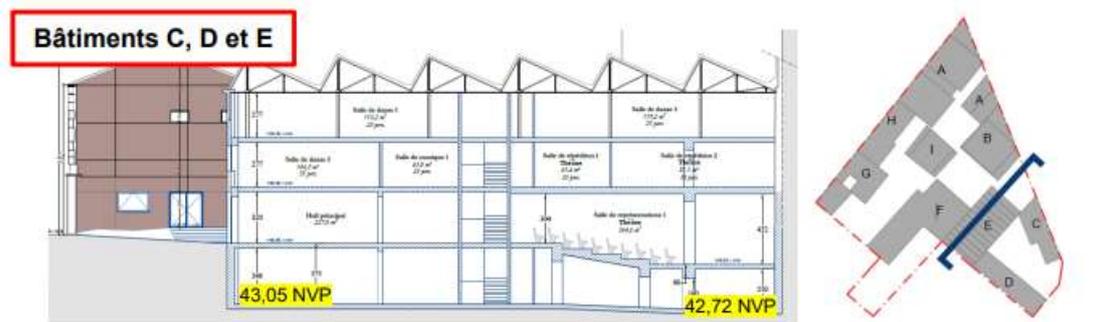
Plan en coupe du sous-sol sur bâtiments C,D et E
